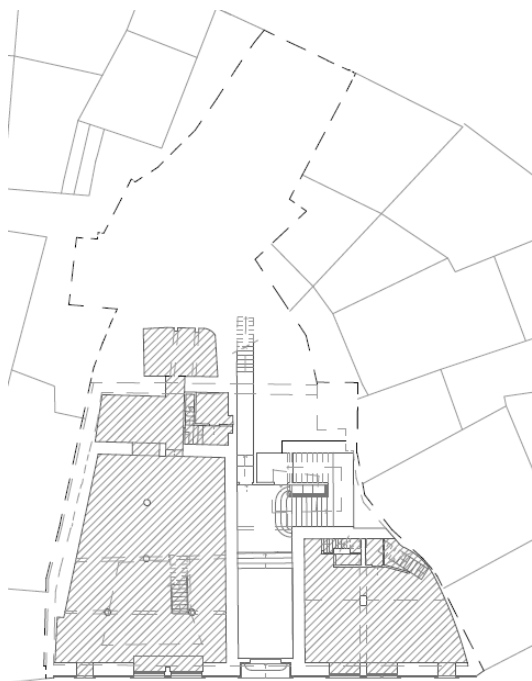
Levantamento da planta do piso 0 do edifício em estudo e piso 0 dos espaços comerciais anexos
